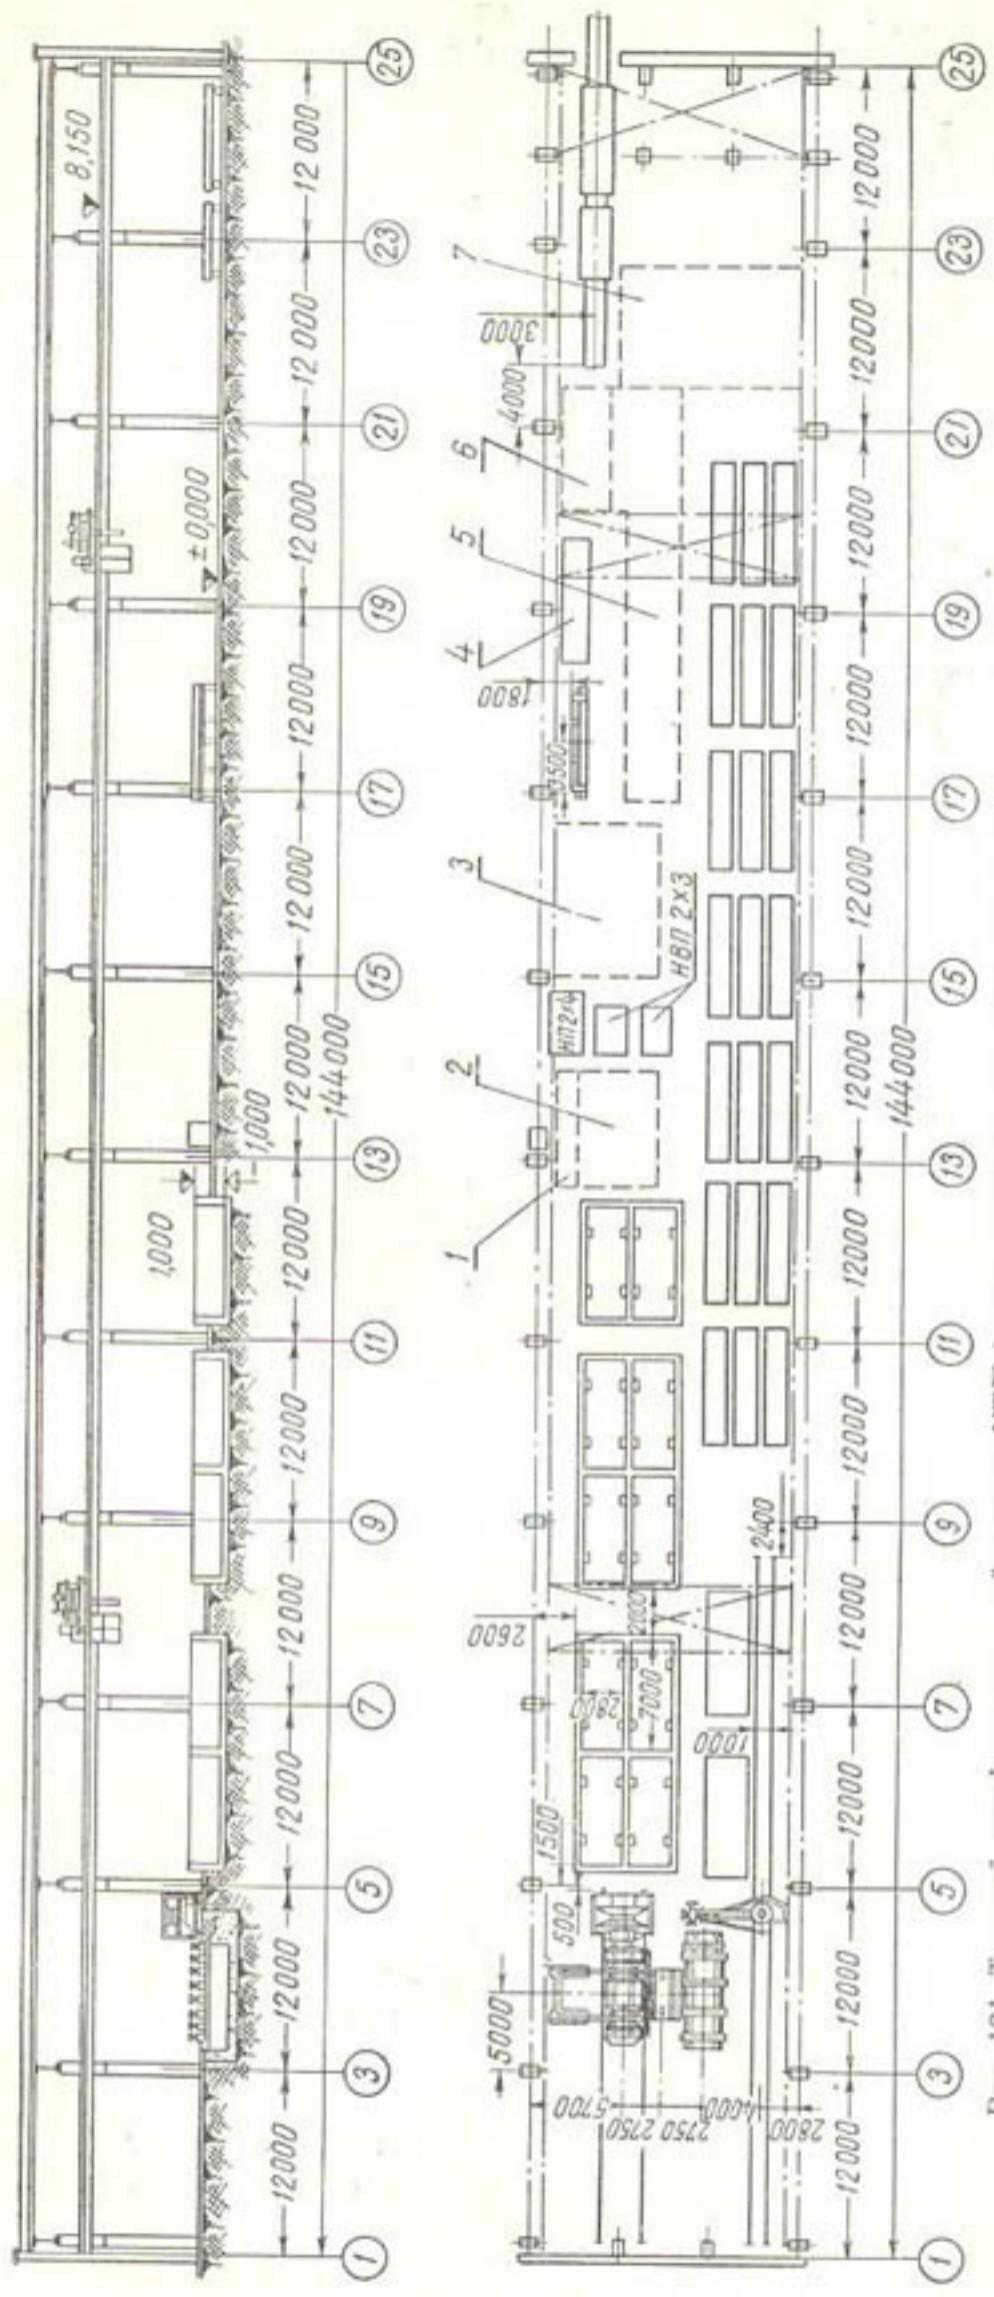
Типовой унифицированный пролет УПТ-1 для производства железобетонных деталей водохозяйственных сооружений:
